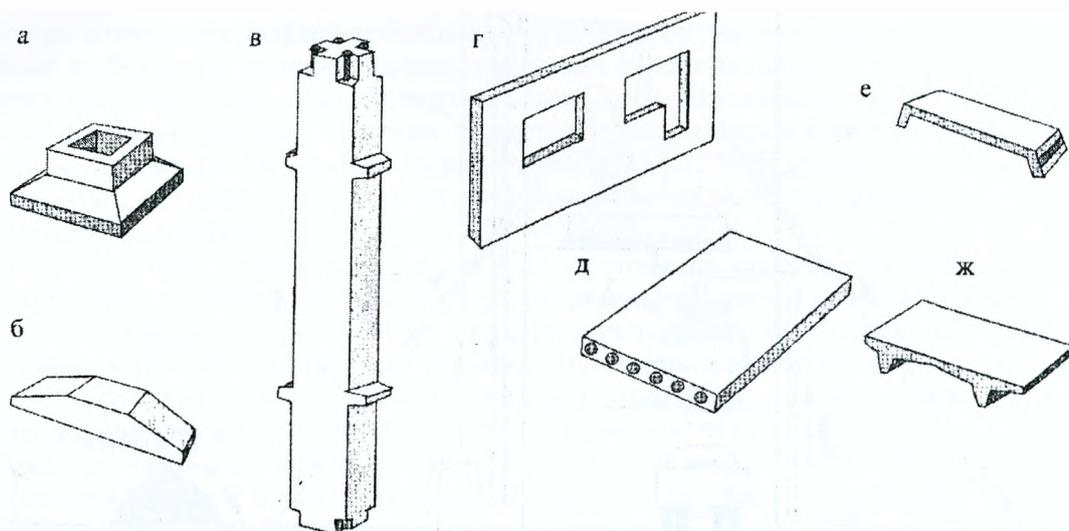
Некоторые виды железобетонных конструкций: а – фундамент под колонны; б – блоки ленточные фундамента; в – колонна; г – наружная стеновая панель; д – многопустотная плита; е – ребристая плита; ж – плита 2Т.
